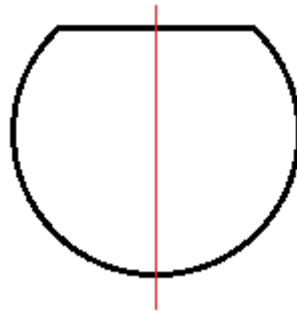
Sección fisurada y eje de simetría y
